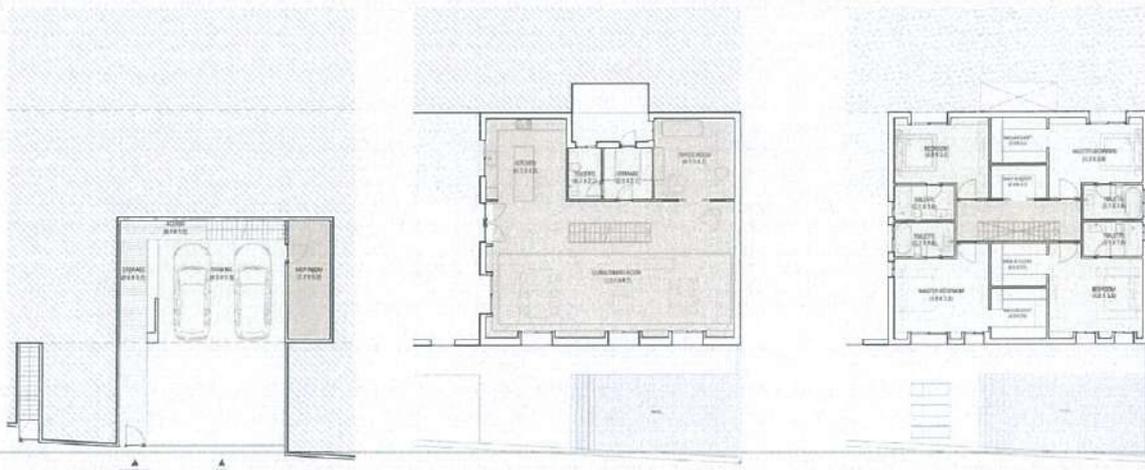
Plani i parkimit, katit përdhe dhe katit të parë të Vilës C
